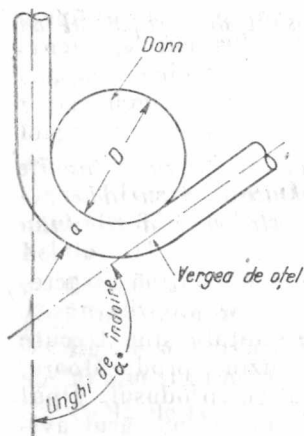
Îndoirea oțelului-beton pe șantier.
